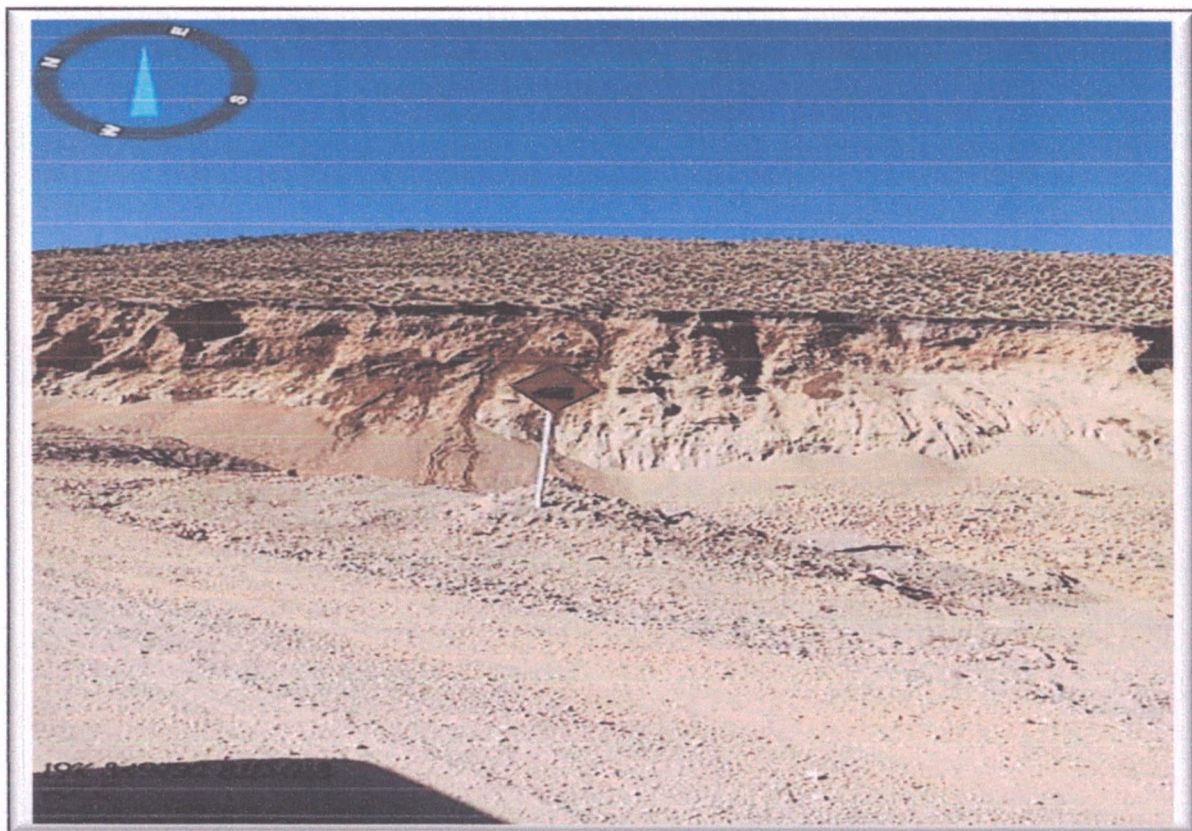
Vista de Cantera 03 (Afirmado) M.I. y señal preventiva.
